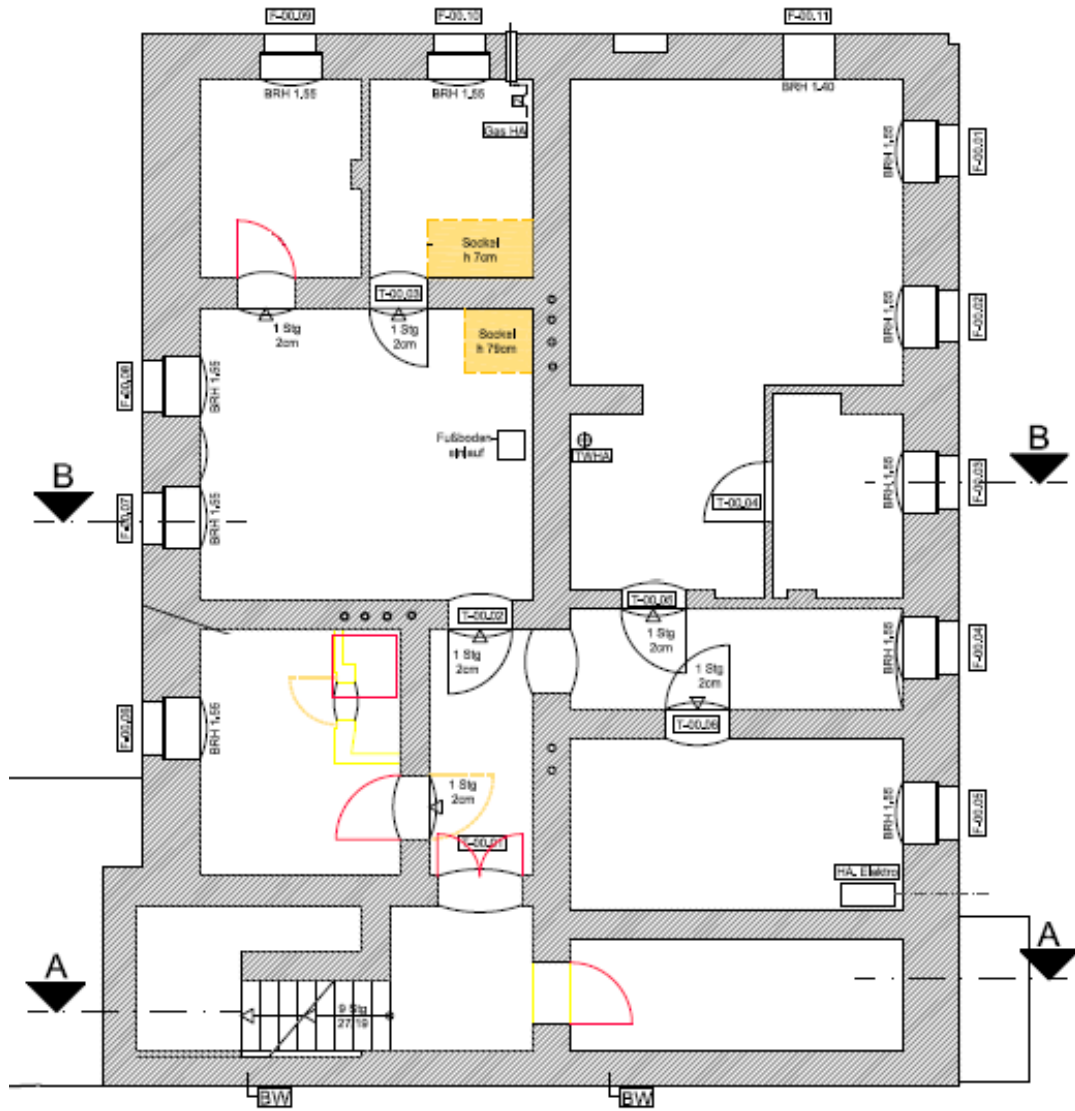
Grundriss Sanierung Kellergeschoss<sup>169</sup>
